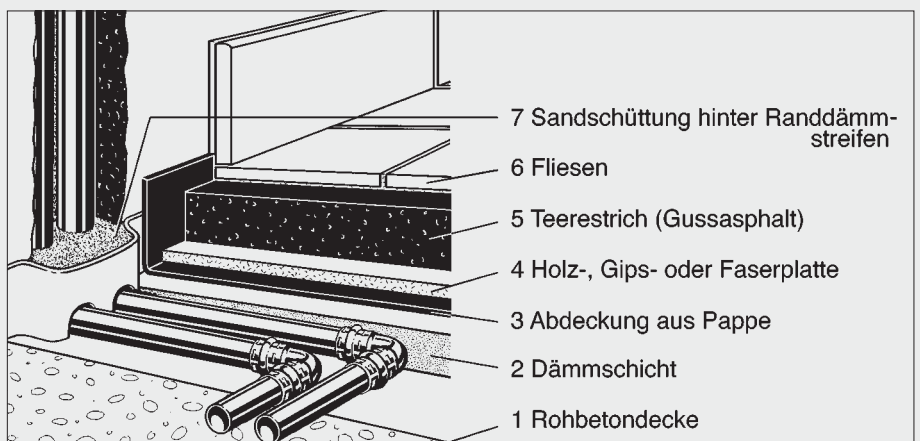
/5: Fußbodenaufbau bei Teerestrich (Gussasphalt)
